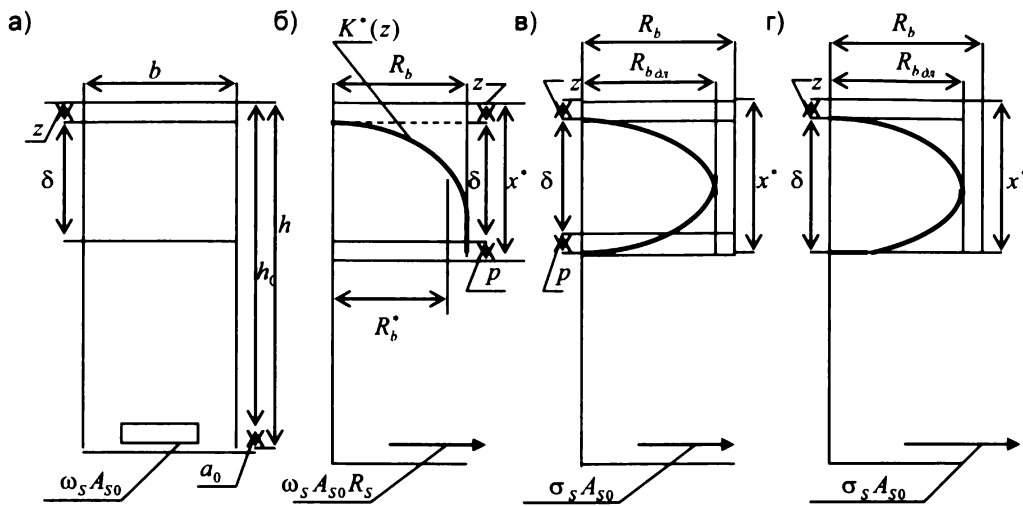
Схема вариантов предельного сопротивления балки с поврежденными коррозией бетоном сжатой зоны и растянутой арматуры и схема напряженного состояния с учетом ограничений, накладываемых условиями устойчивости
